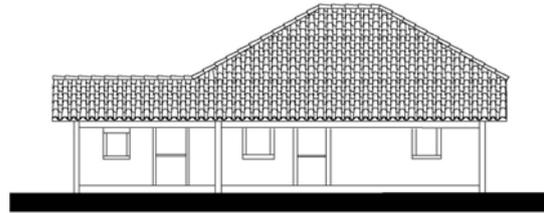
Fachada Nordeste (Acervo PROAU/FAU/UnB).
